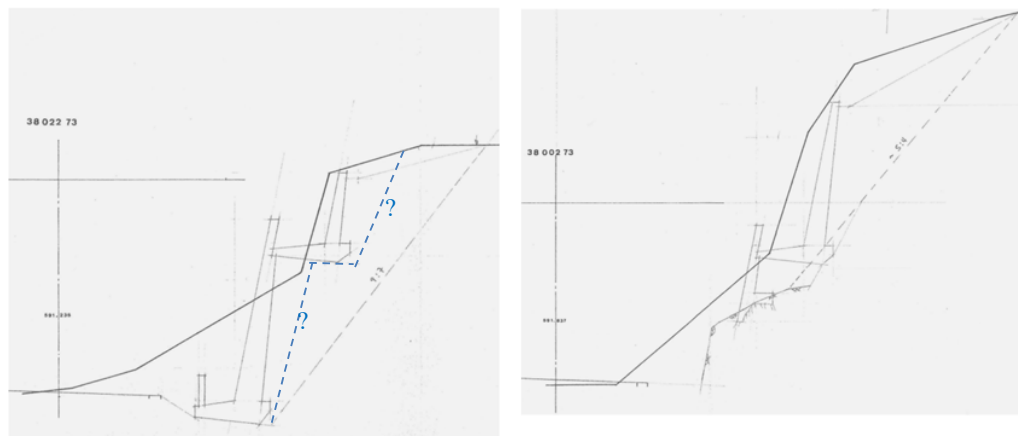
Geböschter Aushubraum für Geometrietypen A2 und B2 gemäß Ausmaßskizze
